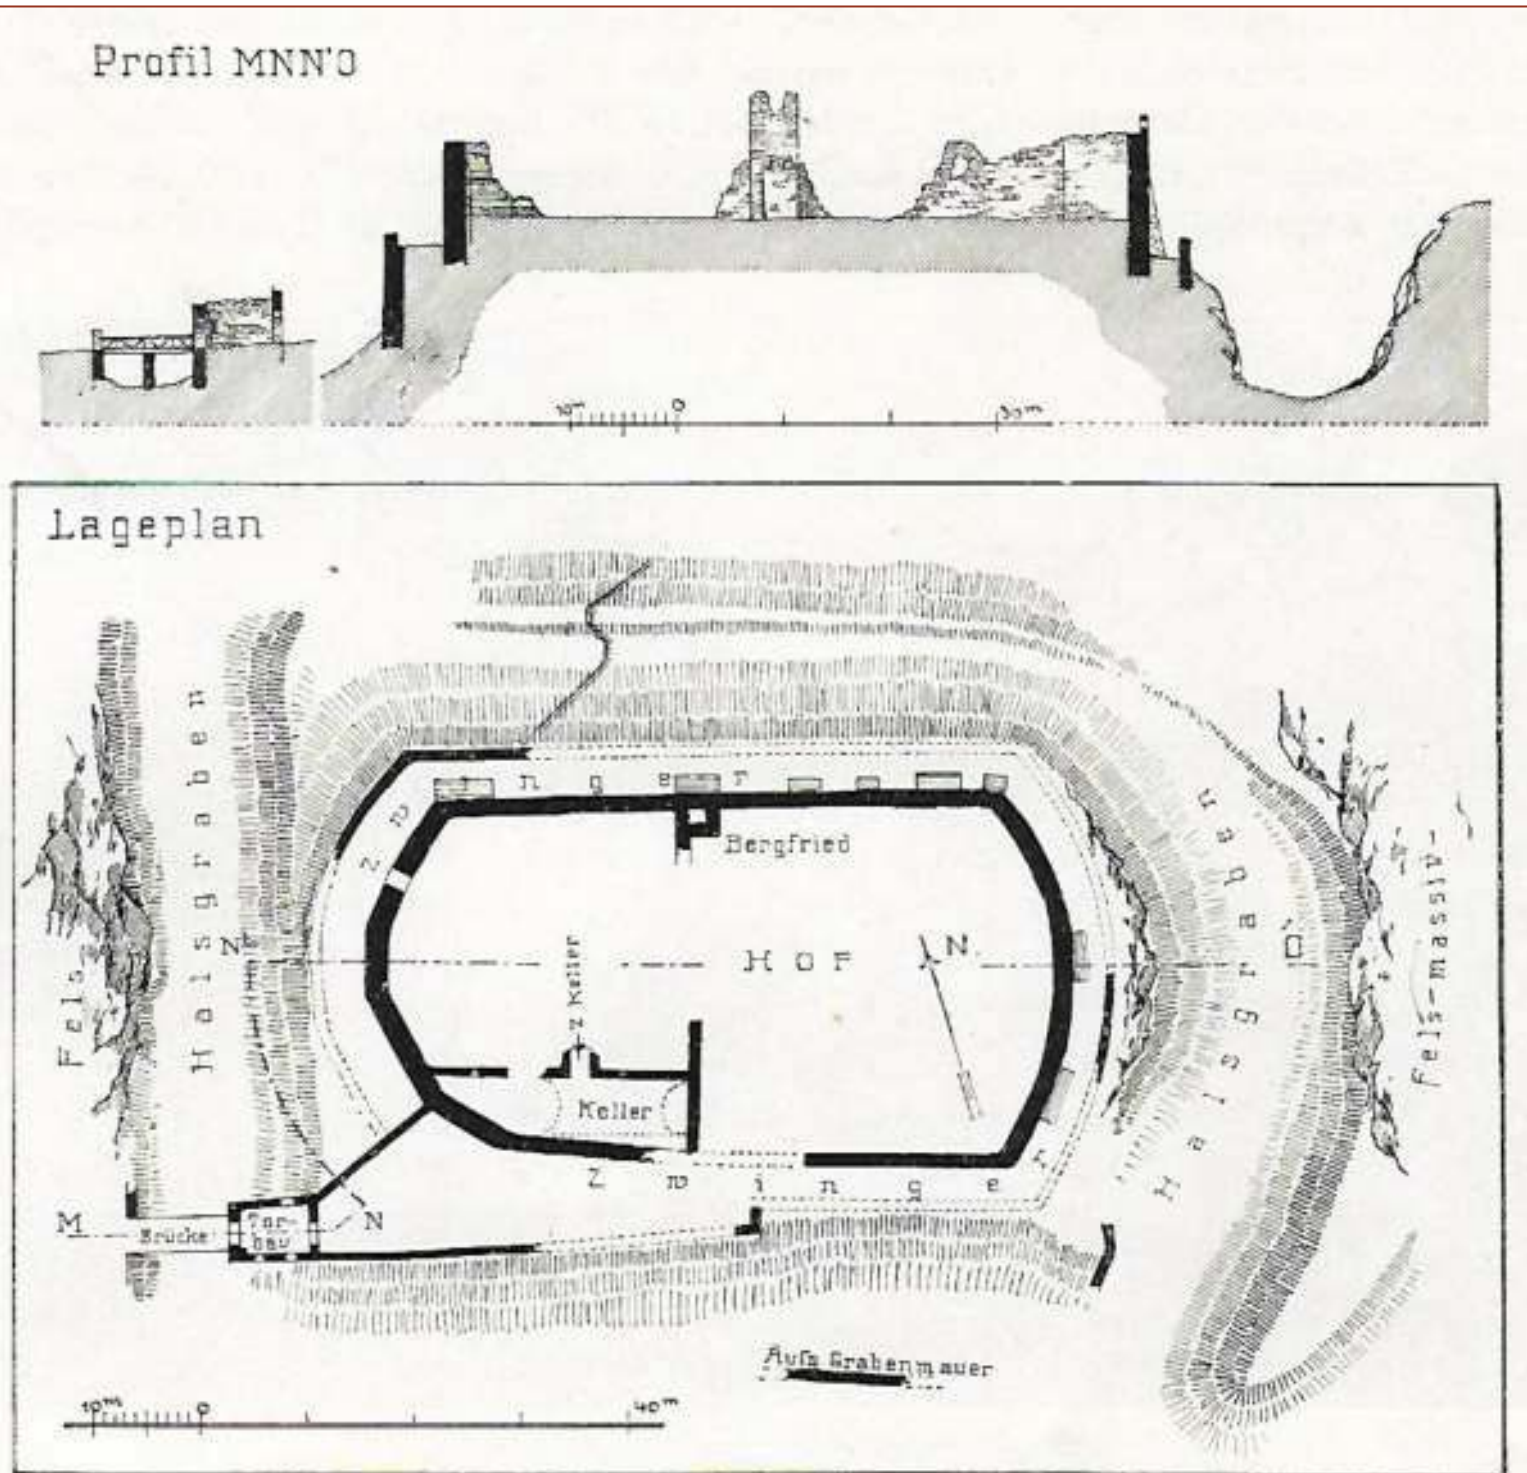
Wildenstein, Burgruine. Lageplan und Profil.
